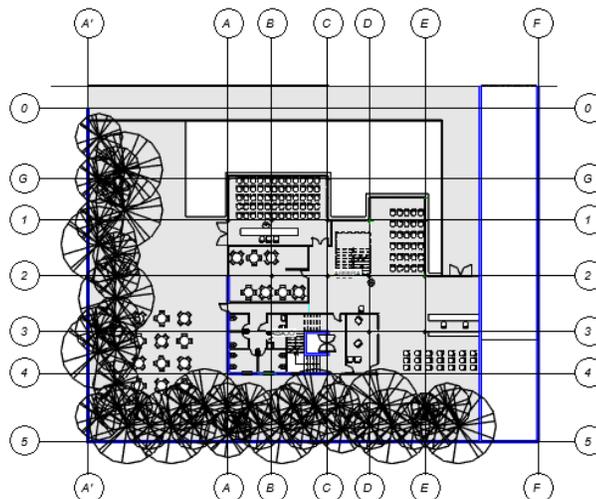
Muros de 20 centímetros seleccionados en la vista en planta del modelo Centro de Salud. Aquí no se definió nuevamente el filtro en base a reglas, sino que se utilizó la plantilla de vista guardada del ejemplo anterior en el que sí se utilizó el filtro.
